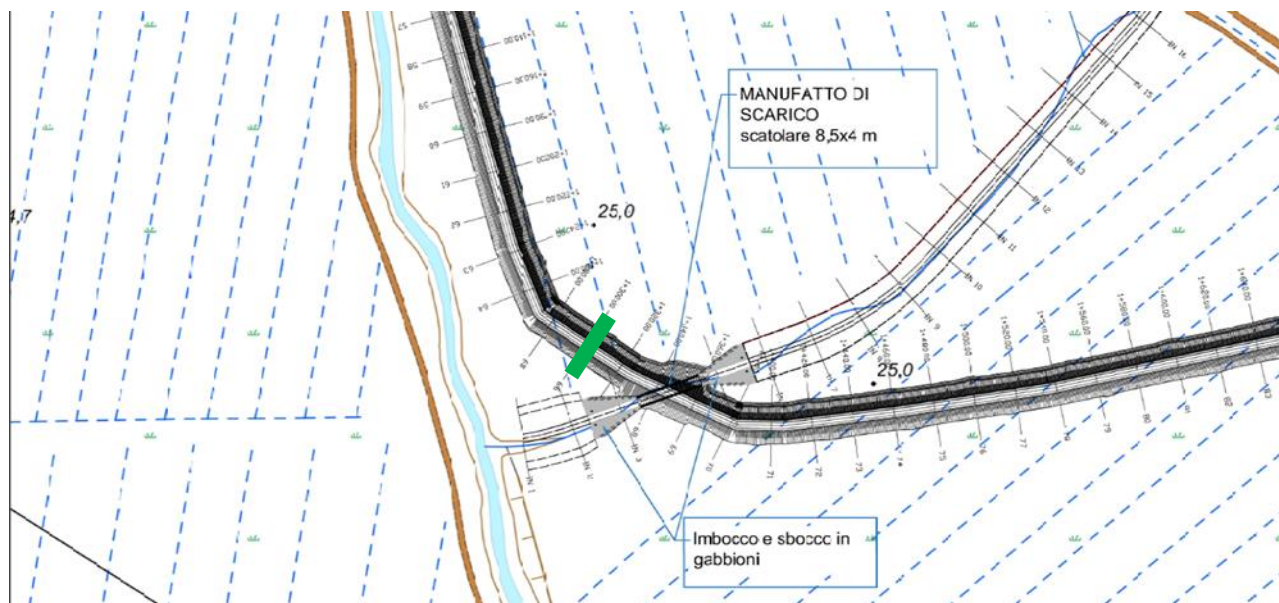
Posizionamento nuovo accesso argine Capena (sezione 66)
